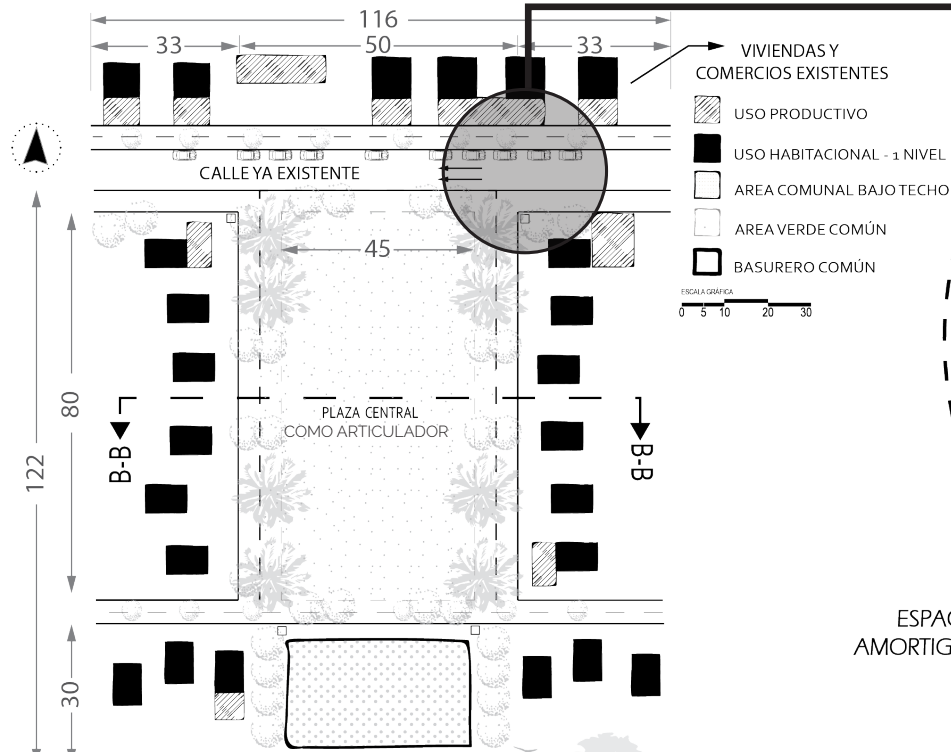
Detalle de transición entre plaza central y amenidades
